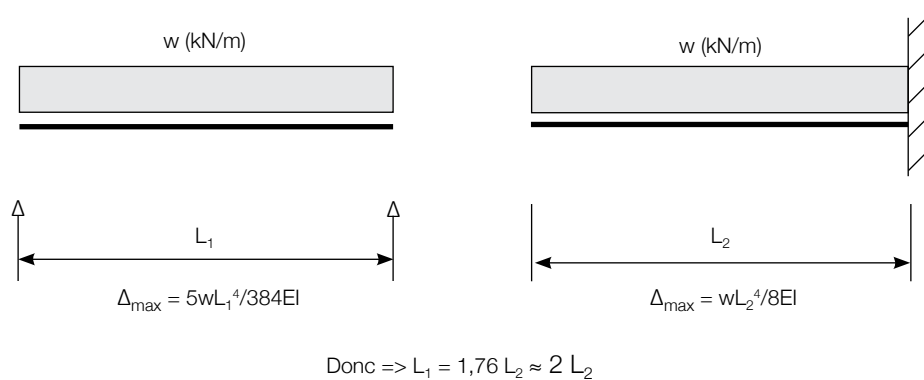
• Comparaison d'une poutre en portée simple avec une poutre en porte-à-faux
